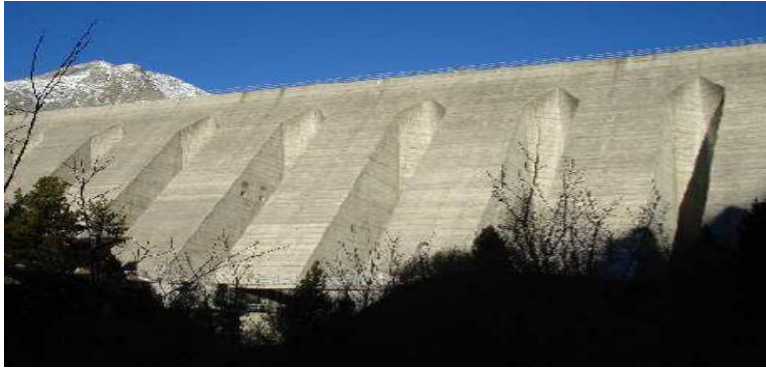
Barrage poids à contreforts de Plan d'Amont (Aussois)
